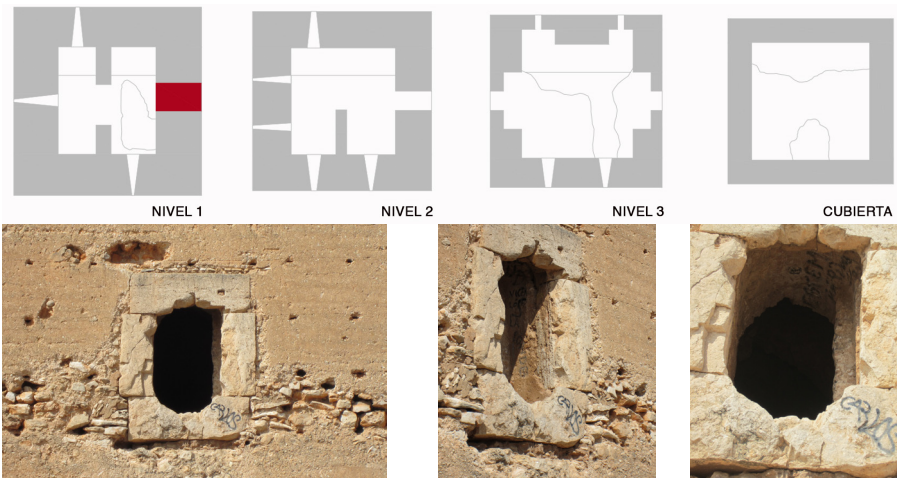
6.73. Vistas exteriores del acceso en la fachada Este.
